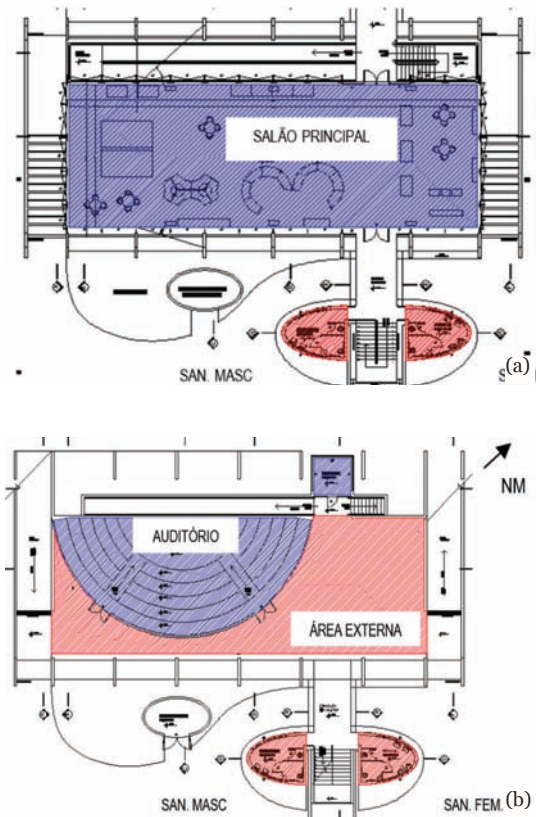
(a) Planta baixa do Pavimento Térreo e (b) Pilotis do CSS.
